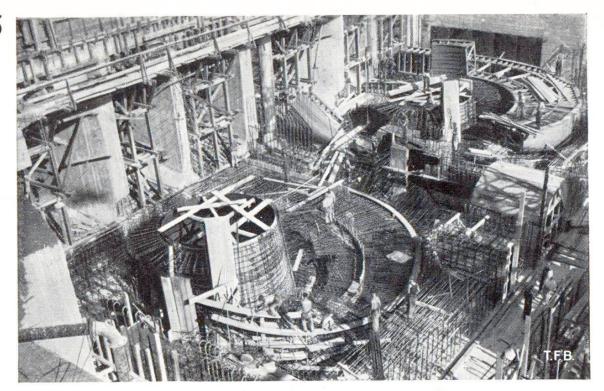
Au premier plan: Armature de la semelle d'une bâche spirale A l'arrière-plan: Coffrage et armature d'une bâche spirale
